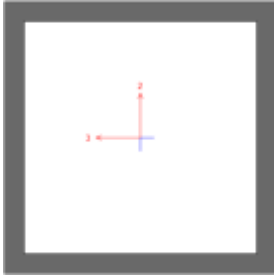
Acero Estructural, sección de columna D-1 (HSS 4x4x1/4)
